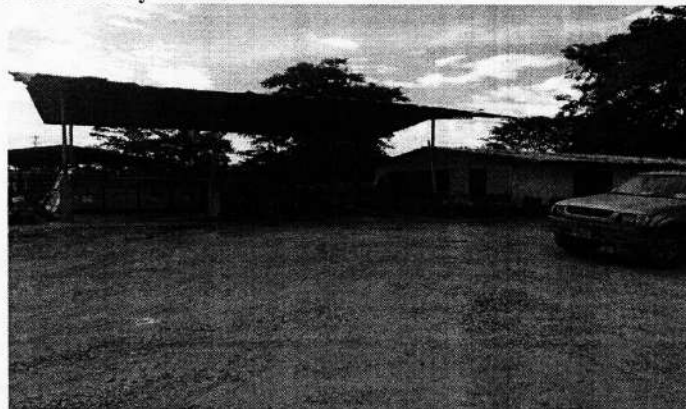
Vista general área de mantenimiento y talleres, construcción de canales perimetrales y piso duro en concreto.
